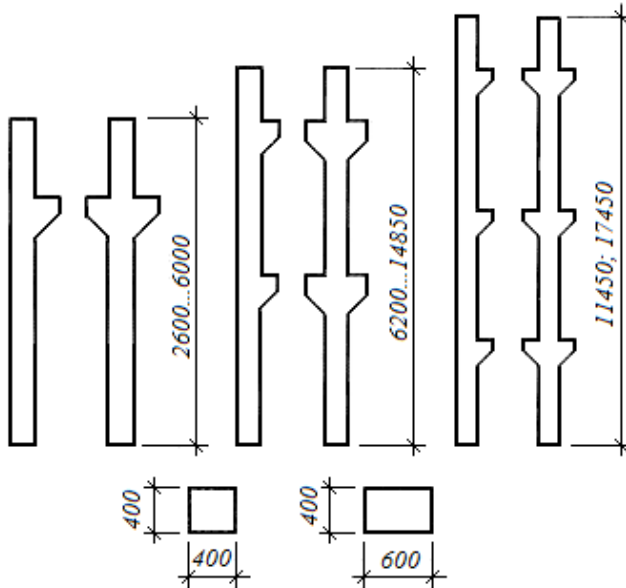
Типи залізобетонних колон багатопверхових виробничих будівель при оперті ригелів на консолі колон
